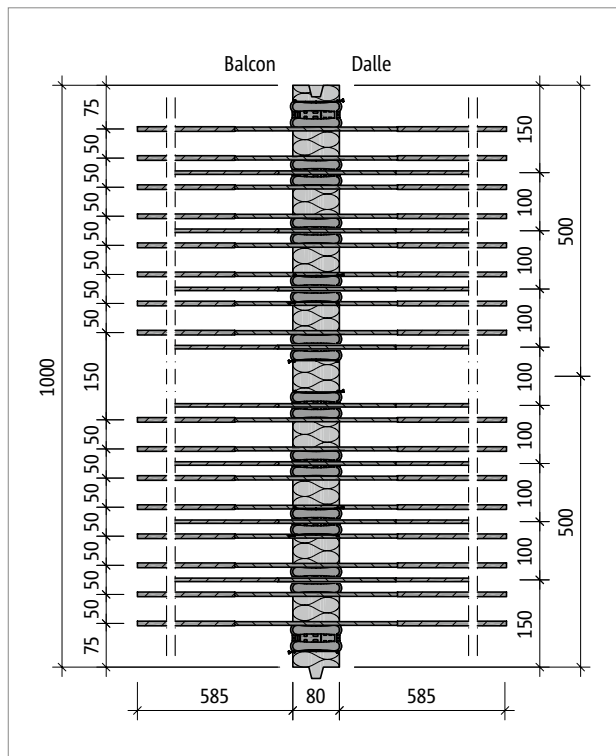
Schöck Isokorb® T type K-T-M5-V1 : plan de base du produit
